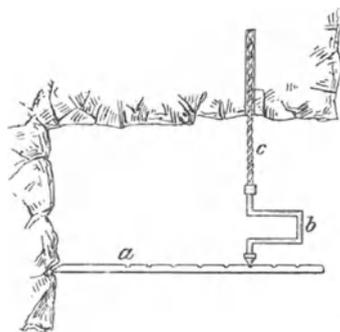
Schlangenbohrer mit Kurbel und Bohreisen.
